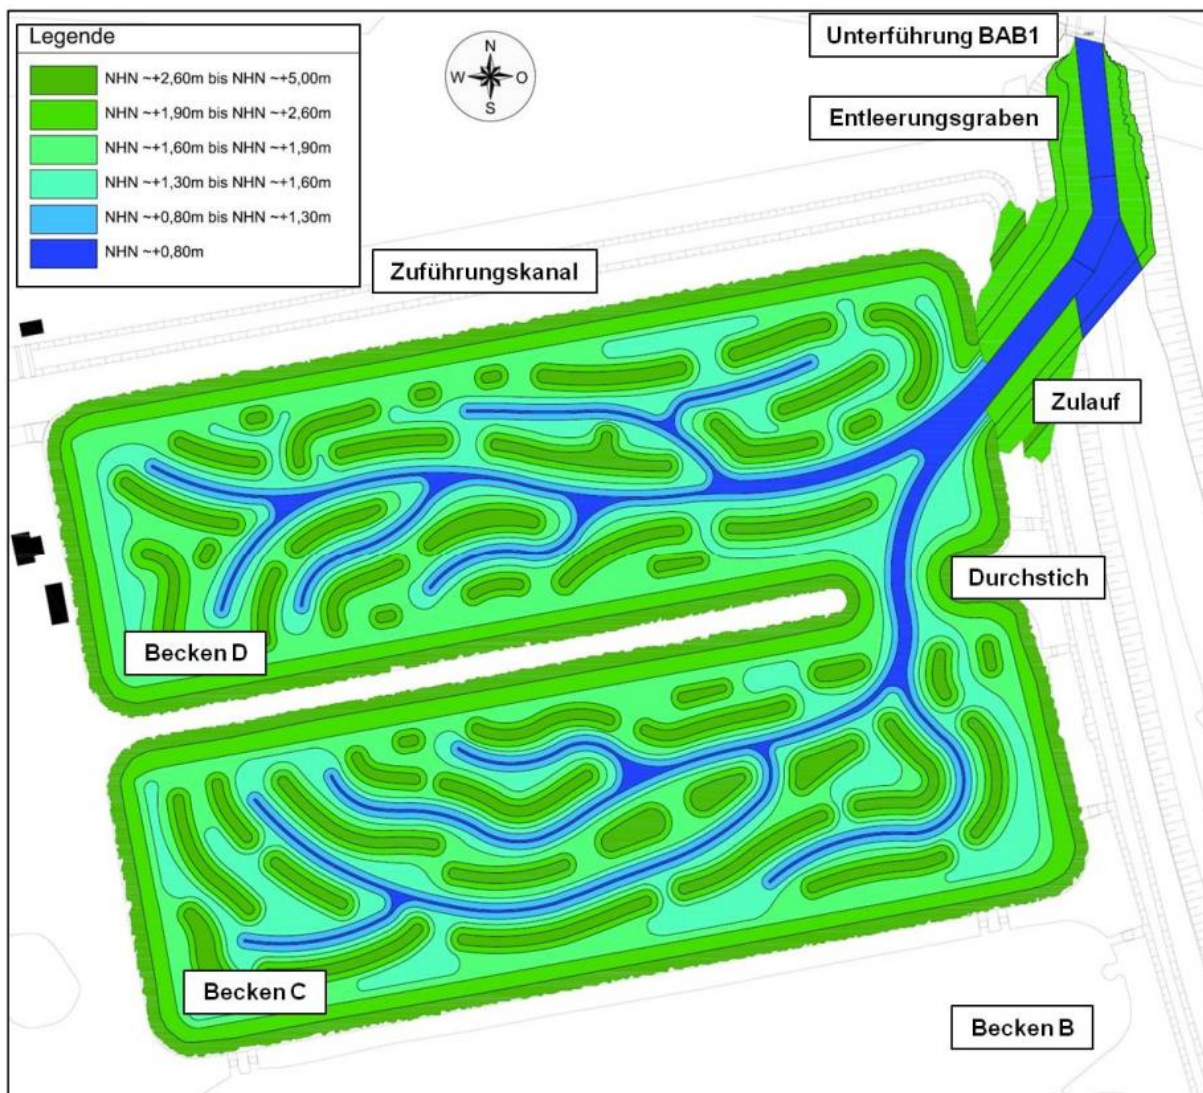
Zu untersuchende Variante mit zwei umgestalteten Becken. (Quelle: WKC Hamburg GmbH, 1.2 Technische Planung, Fahrrinnenanpassung Unter- und Außenelbe, Tideanschluss Billwerder Insel, 30.01.2018).
